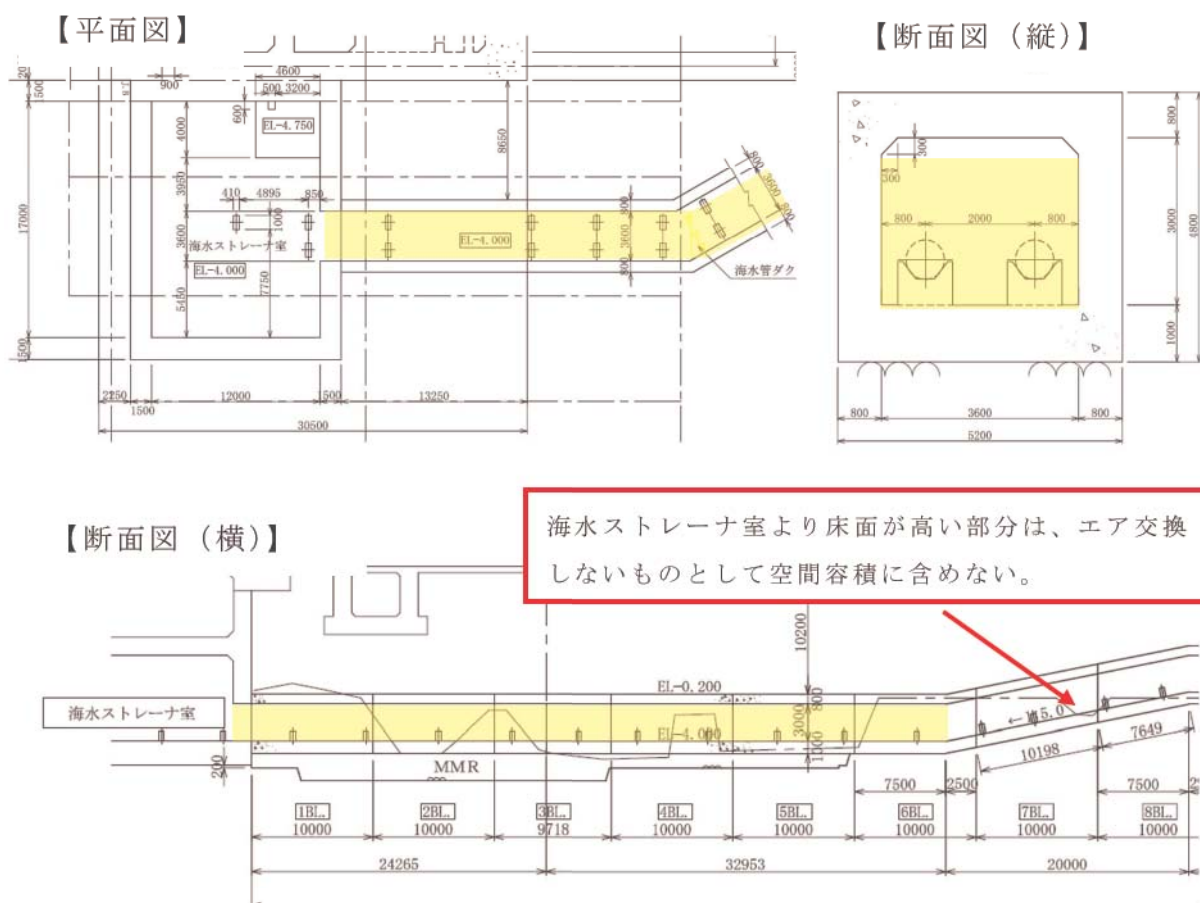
原子炉補機冷却海水管ダクト平面図及び断面図
